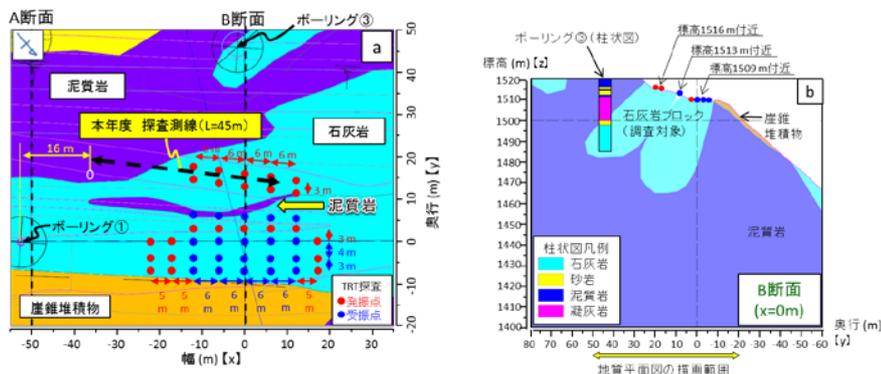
a: 地質平面図, b: 地質縦断面図(B断面)
